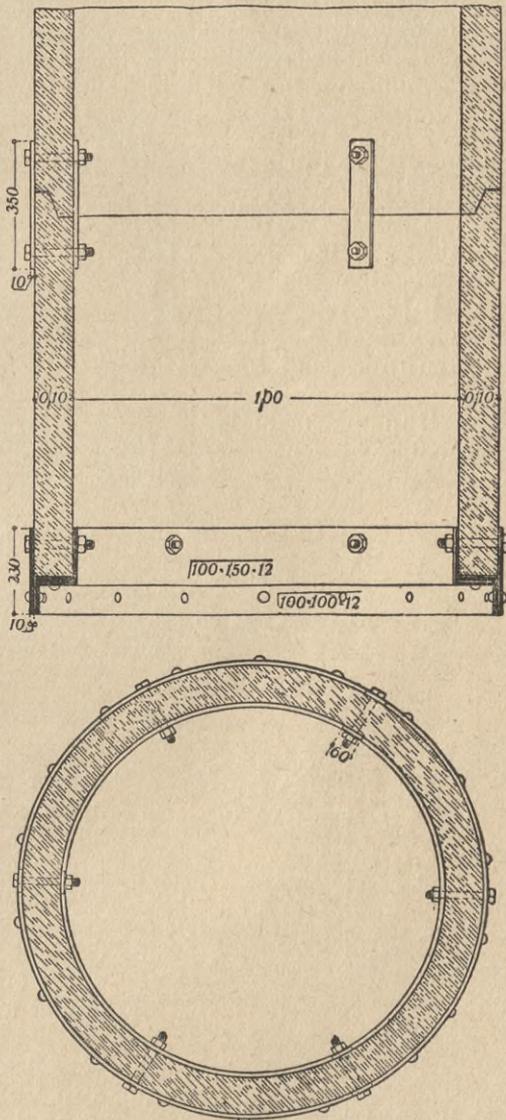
Brunnenringe aus Beton mit Bewehrung der Schneide und Sicherung des Stoßes.
